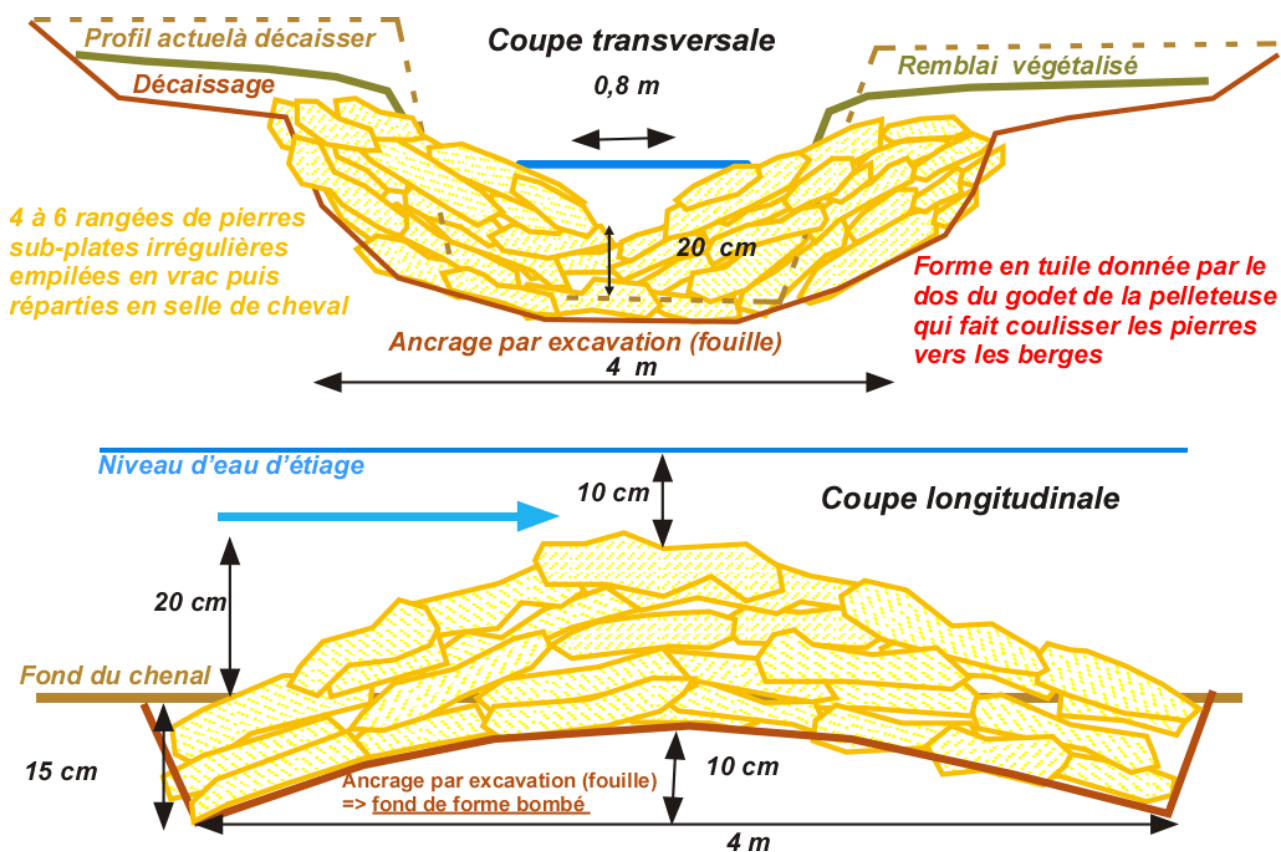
Schéma d'édification et d'implantation d'une semelle de fond
